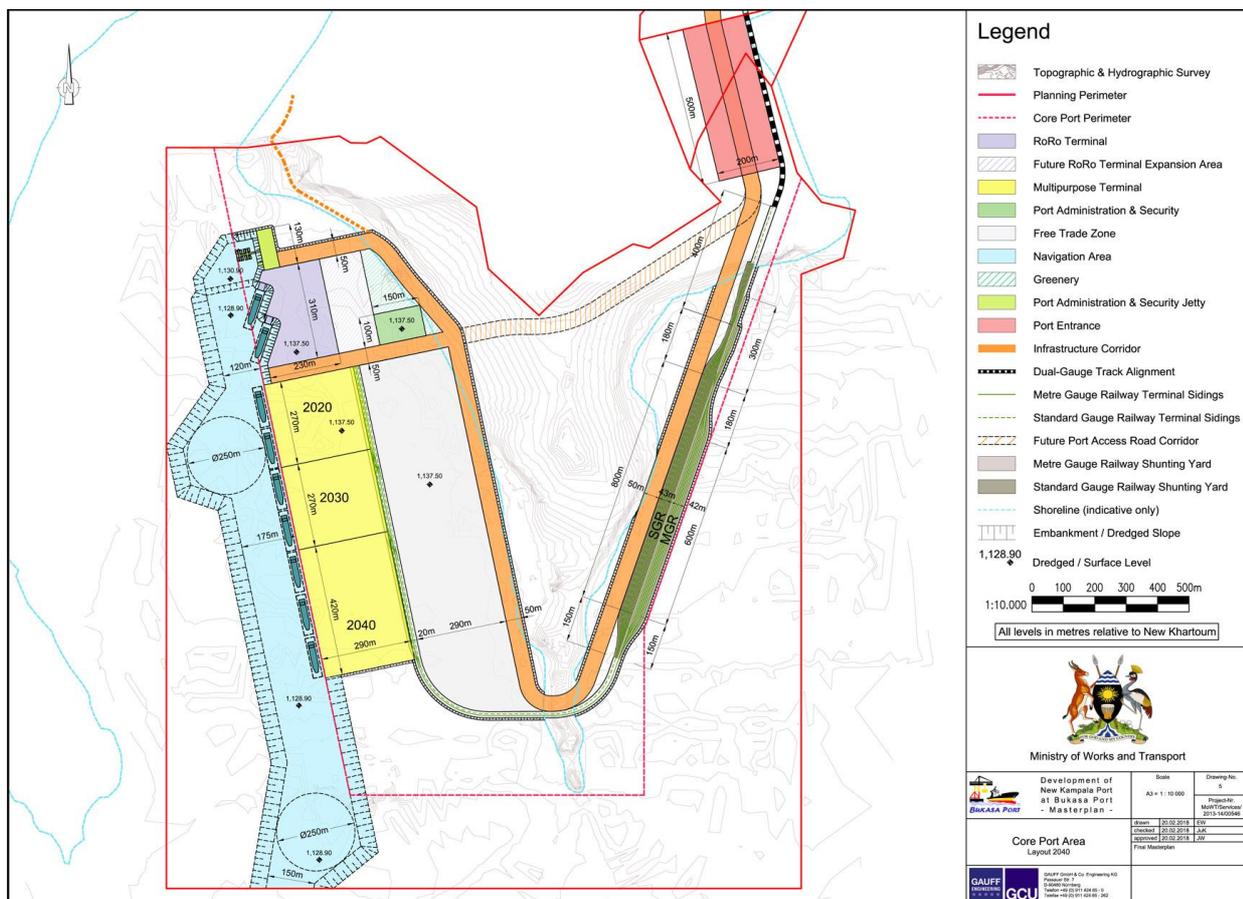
Plan de la constructora para el Bukasa Port (60)
